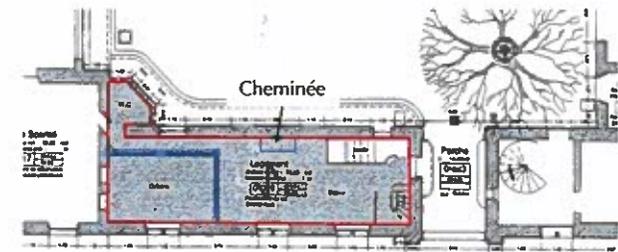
Plancher bas du rez-de-chaussée nécessitant une dépose-restitution, fond de plan transmis par SASU Atelier Cord
